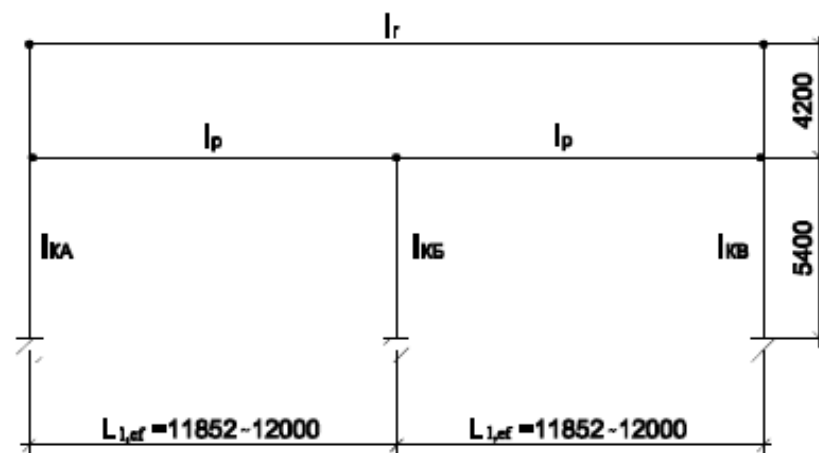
Схемы поперечной рамы каркаса проектируемого здания
